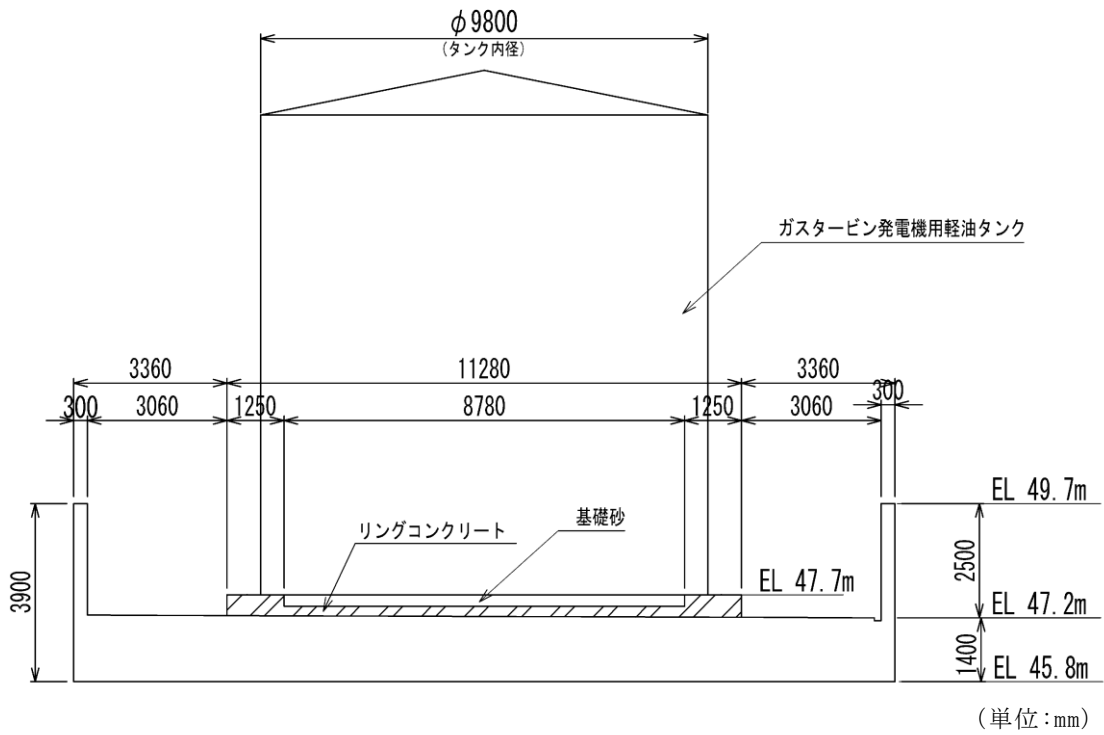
ガスタービン発電機用軽油タンク基礎 平面図
